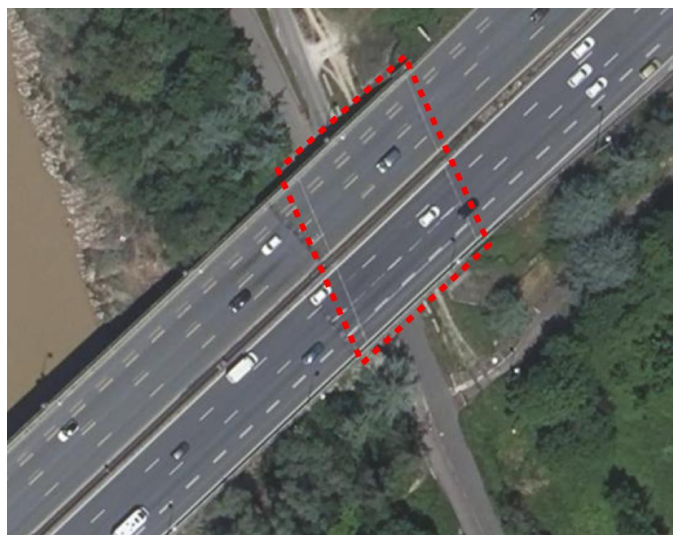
Ouvrage franchissant la route du bord de l'eau
